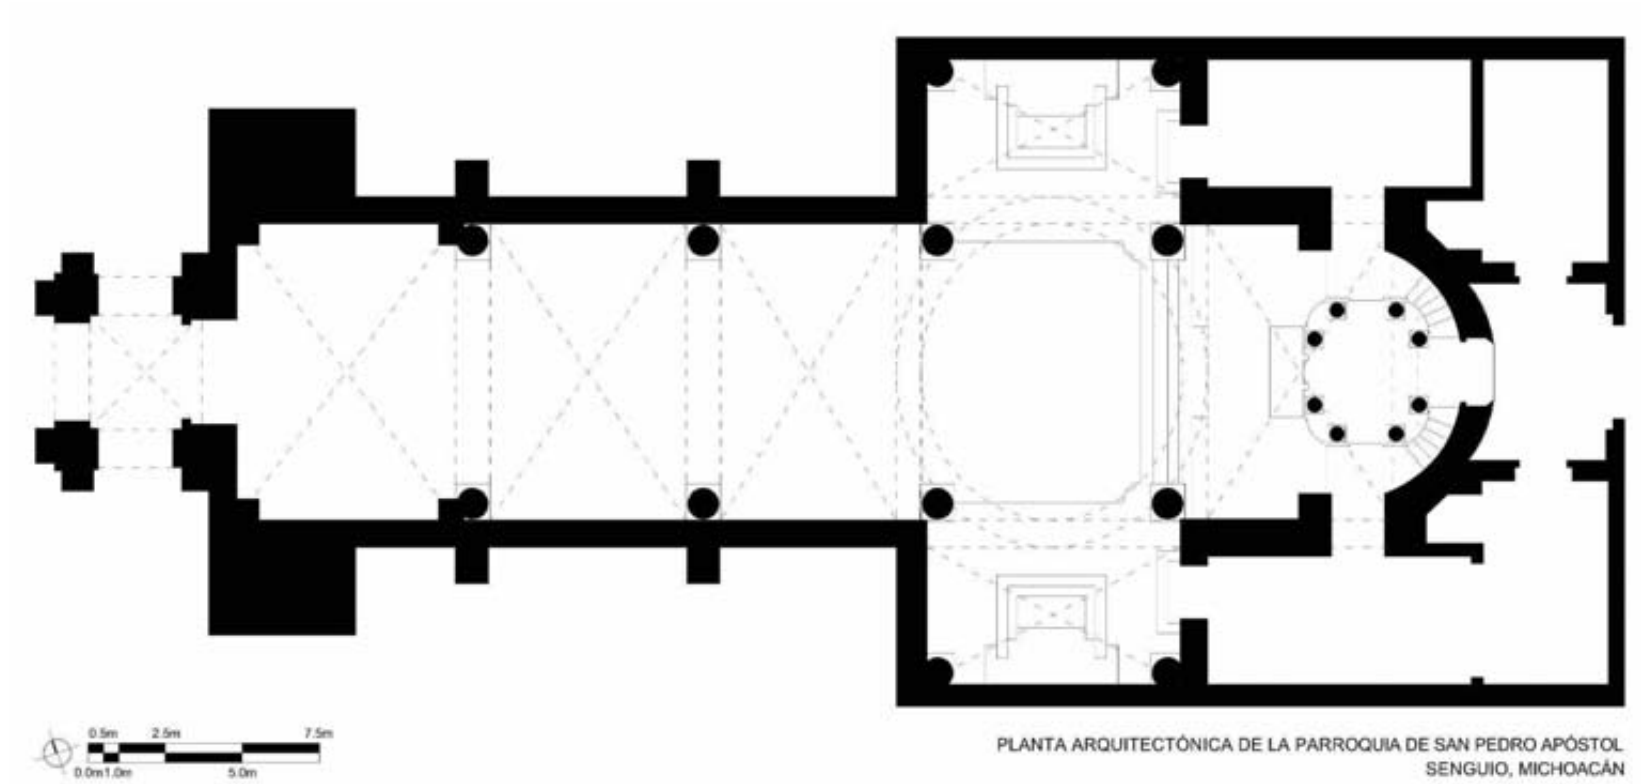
Planta de la Parroquia de San Pedro Apóstol en Senguio
